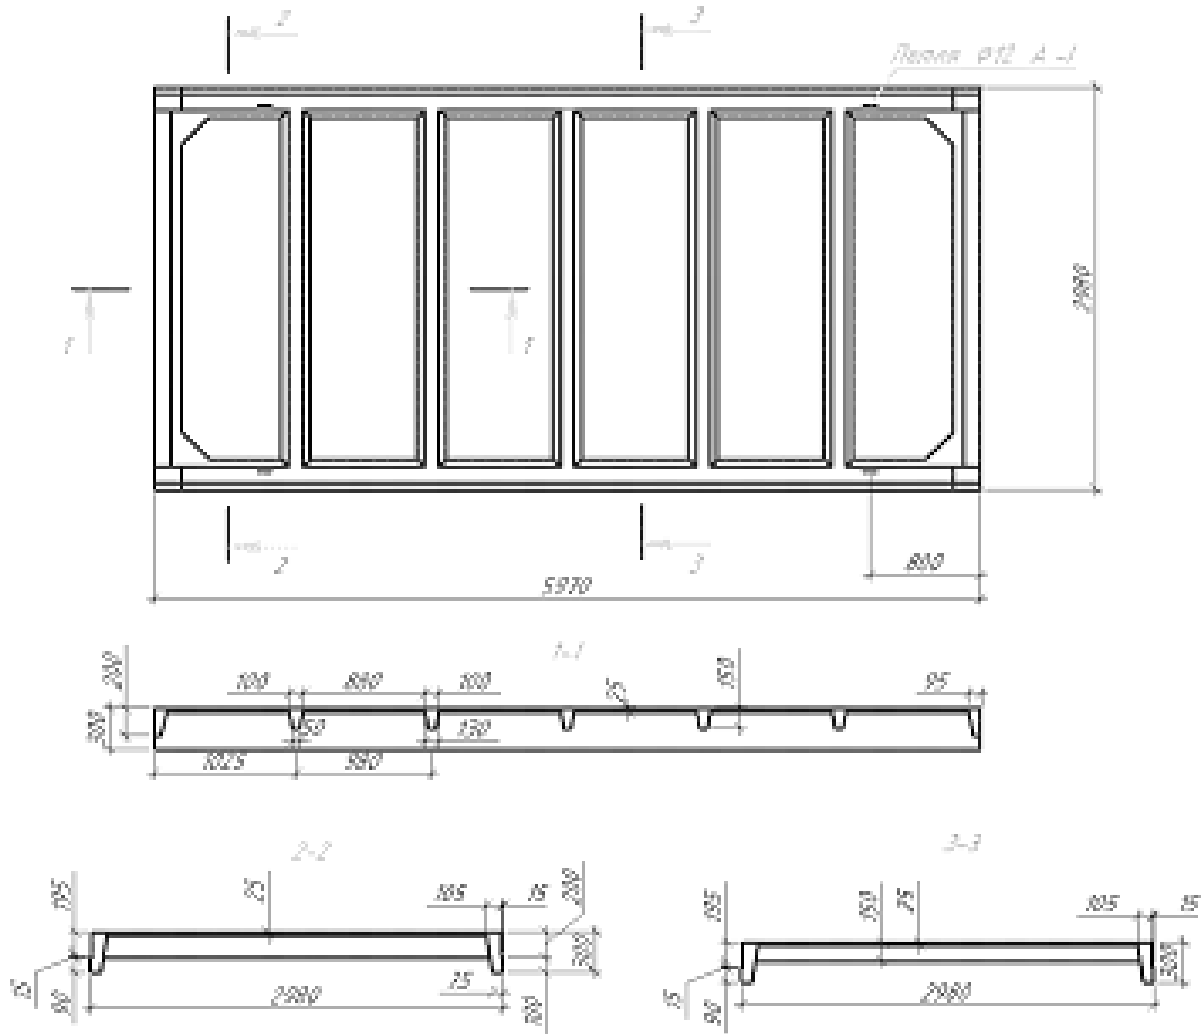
Опалубочне креслення ребристої панелі 3х6 м
